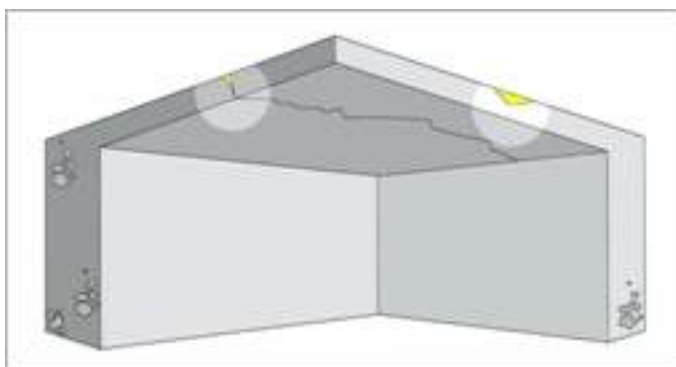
Exemplo de uma trinca em laje de concreto
